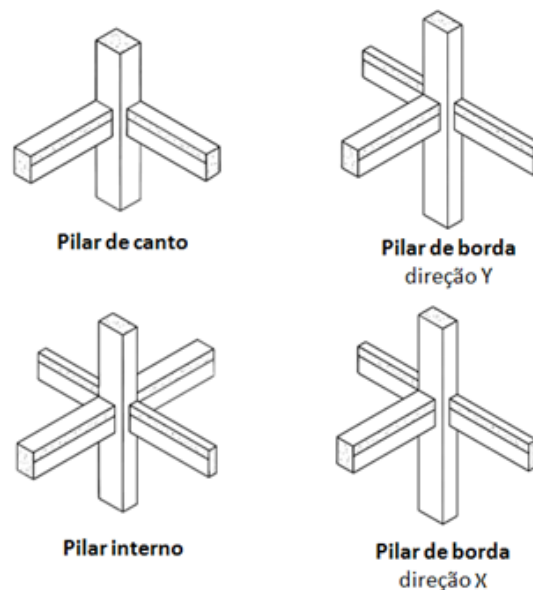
Divisão dos pilares para consideração dos carregamentos
